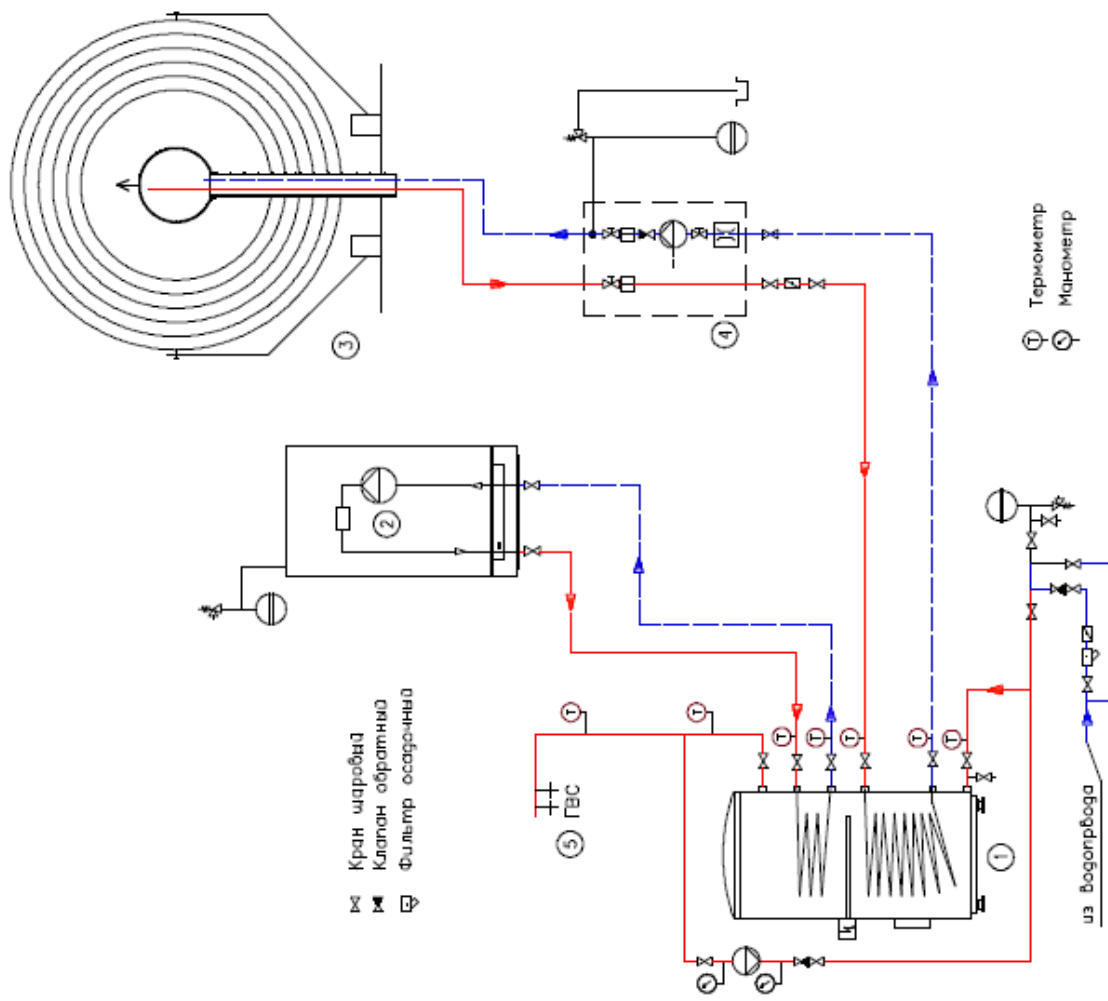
Схема бивалентного приготовления ГВС с емкостным водонагревателем и одноконтурным котлом.
